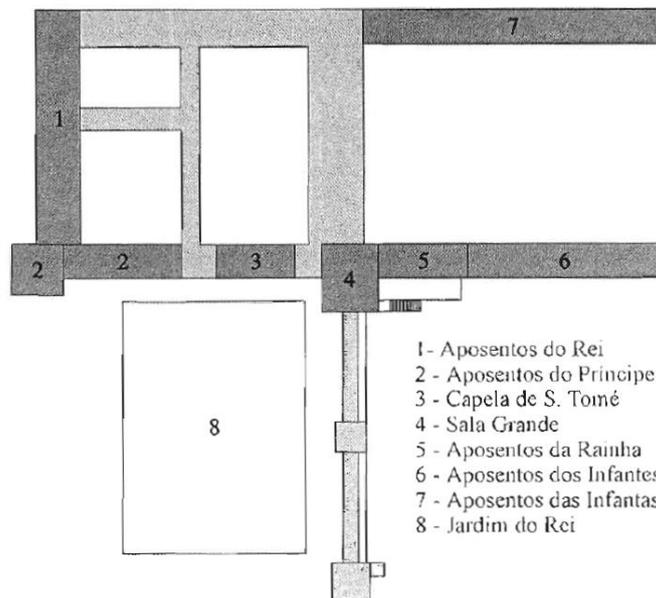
Proposta de reconstituição esquemática da planta do Paço da Ribeira.
